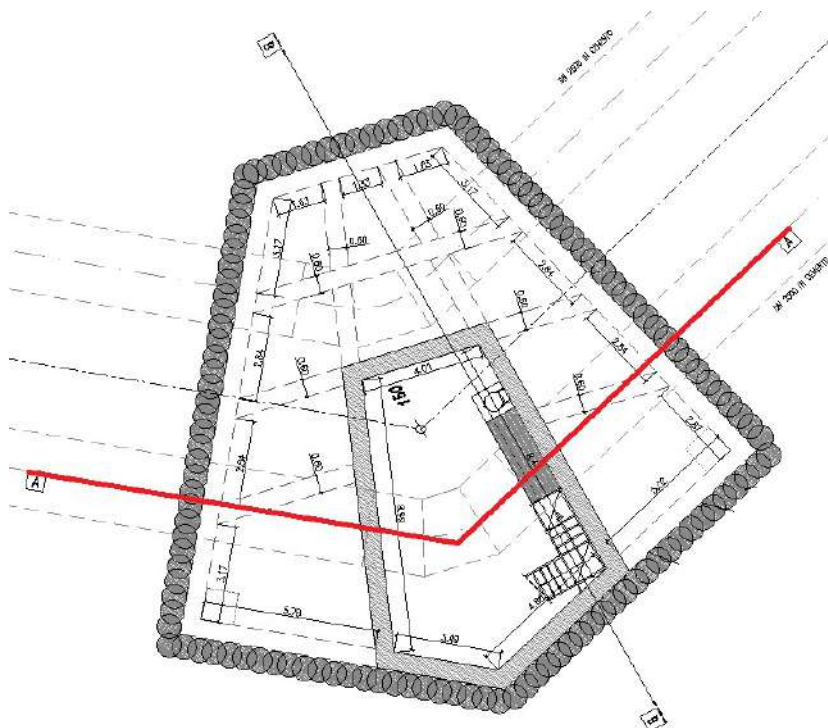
Posizione della sezione di calcolo delle opere provvisorie
